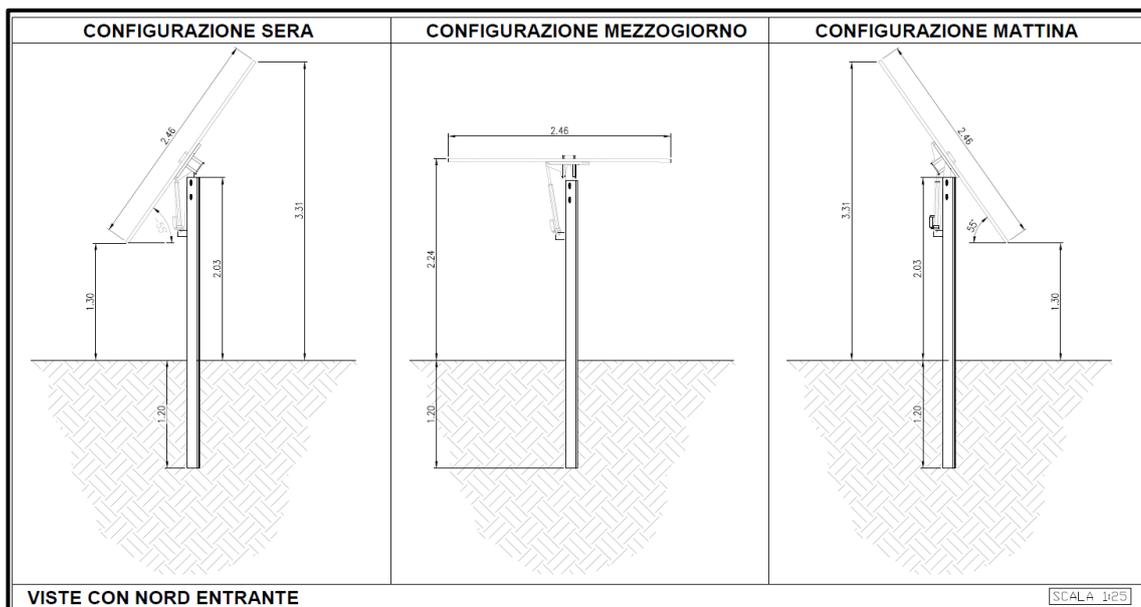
a Strutture tracker: sezione tipo (estratto da tavola AV.MAN.DE.AM.R.027, fuori scala).
